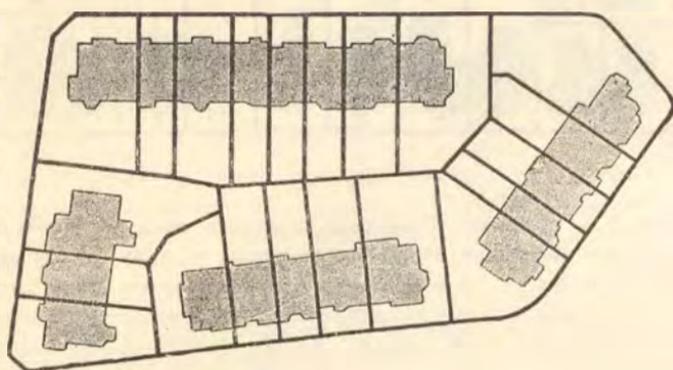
Групповая застройка на Waldschlösschen въ Дрезденѣ.
